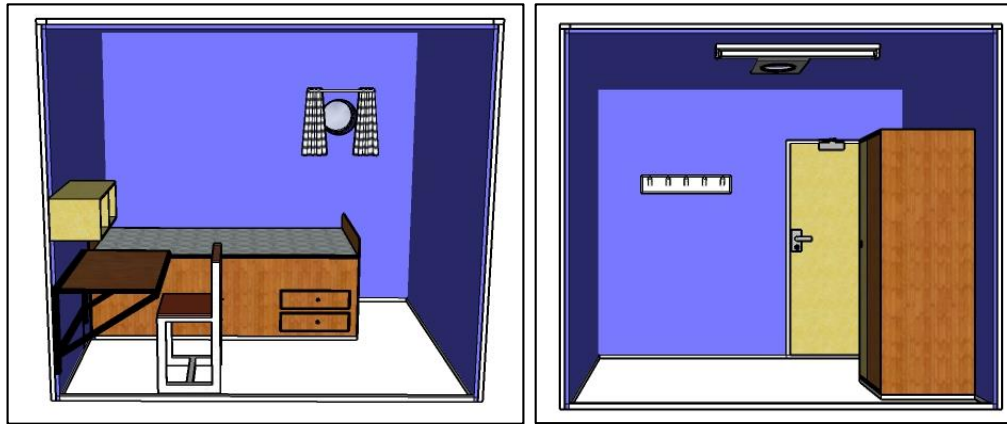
Equipment Installation Modul Captain Bedroom
